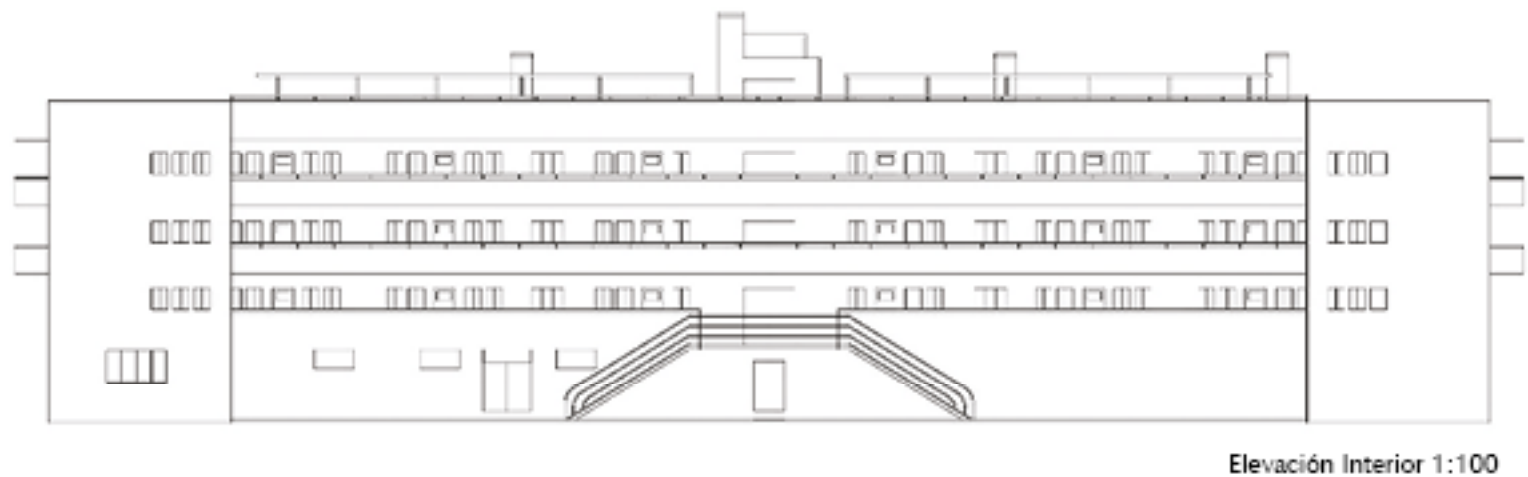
Alzado tipo de los volúmenes colectivos de Arica e Iquique.
